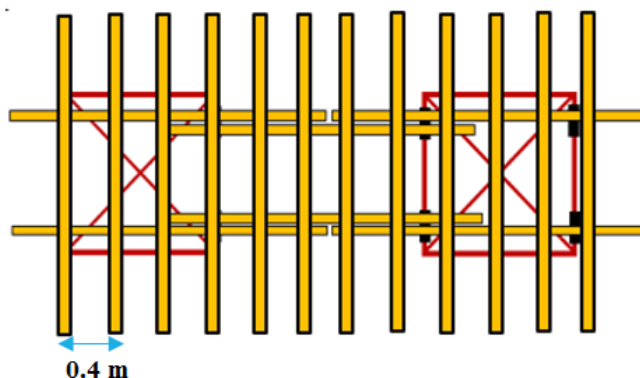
DISPOSITION DES POUTRELLES CONTRE LISSES
